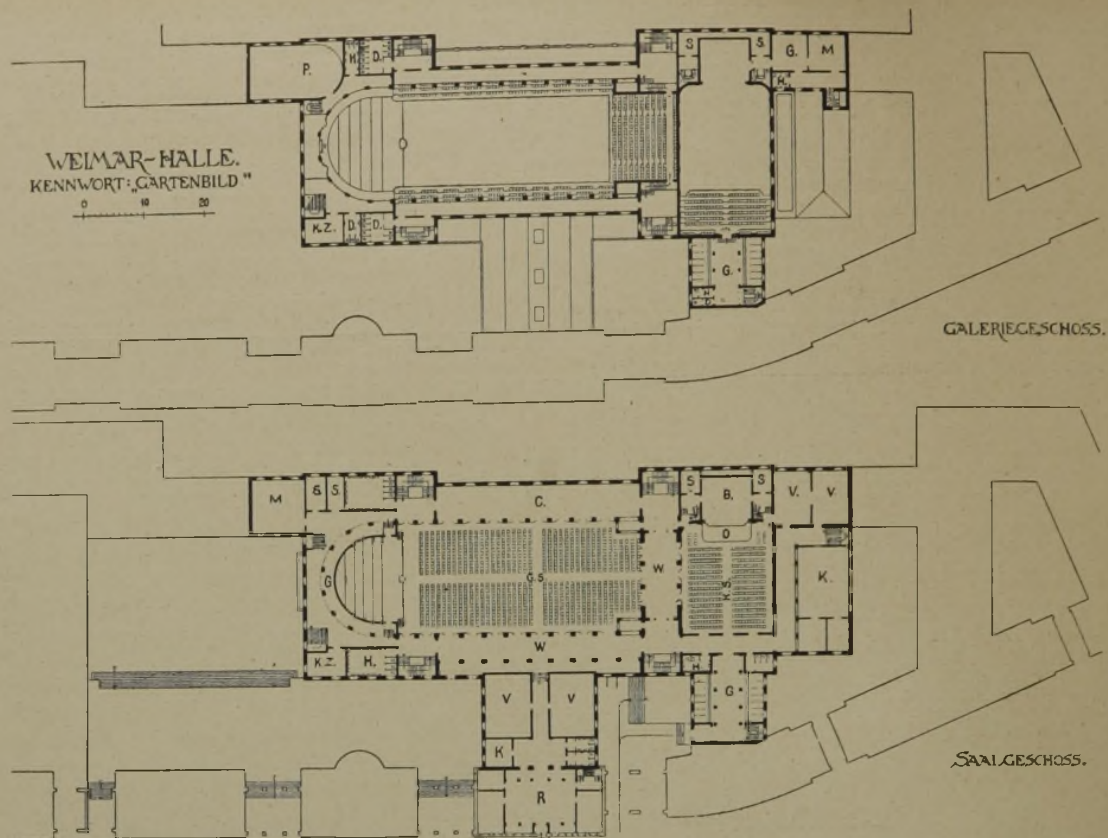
u. 4. Grundrisse von Saal- und Galerie-Geschoß. (Maßstab 1 : 1250.)
